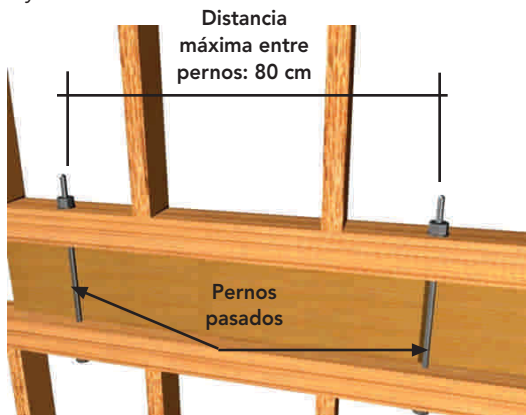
42: Anclaje de tabique perimetral soportante con tirafondos a viga principal de la plataforma de madera montada sobre pilotes.
